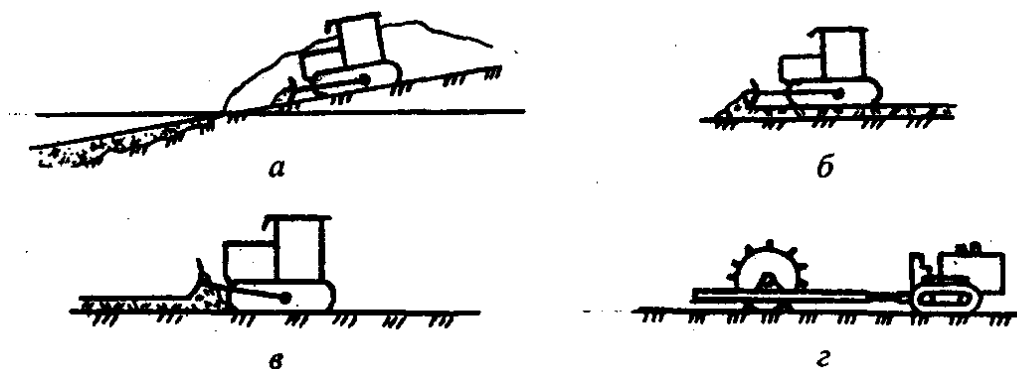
Схема комплексной механизации земляных работ при разработке грунта бульдозером:
